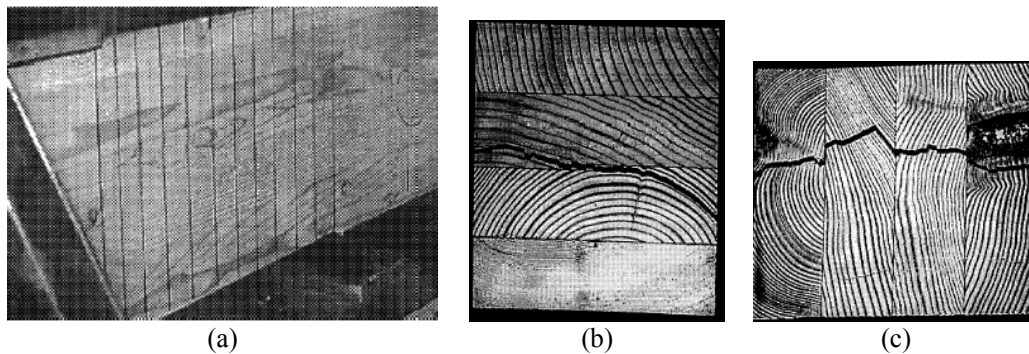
(a) Falhas de cisalhamento na viga, e (b) e (c) parte da falha na seção transversal.
